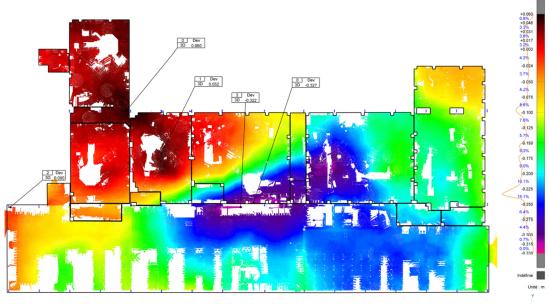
Mise en évidence de l'affaissement d'une dalle.
